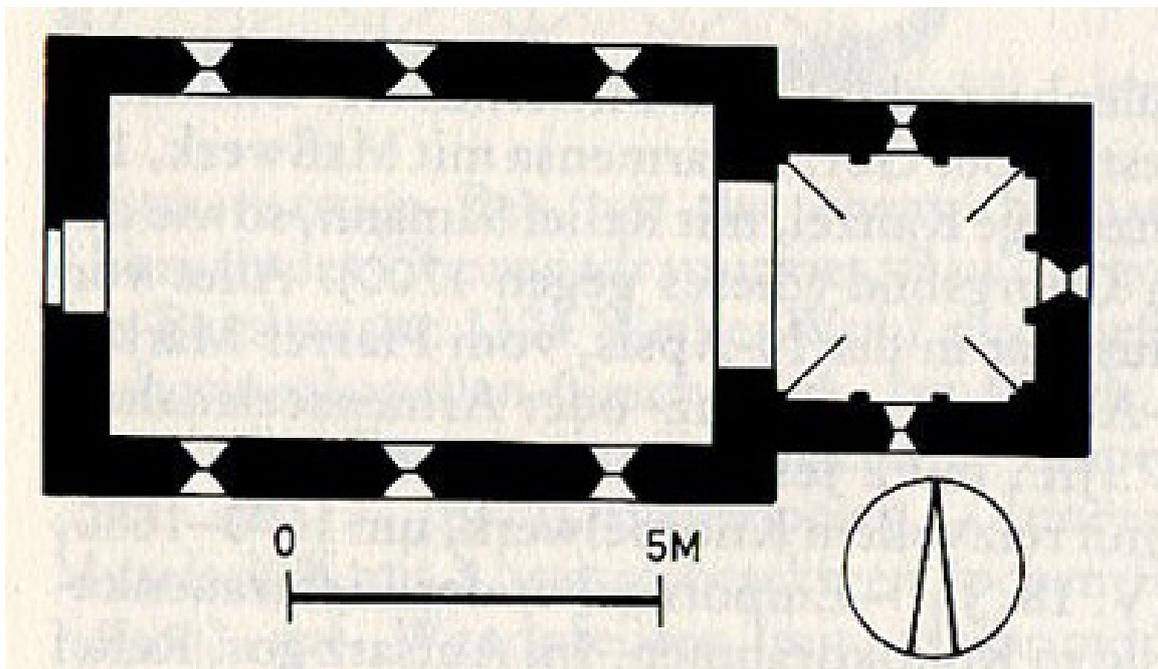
Pürgg, Grundriss (Dehio 1982)
